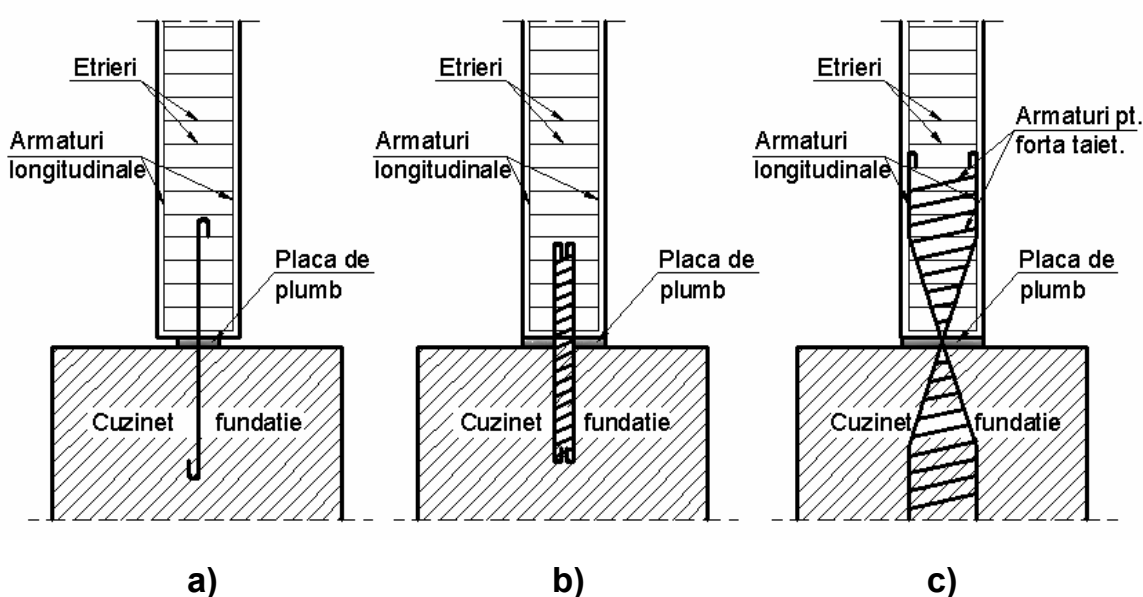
Realizarea articulațiilor la podurile din beton armat
